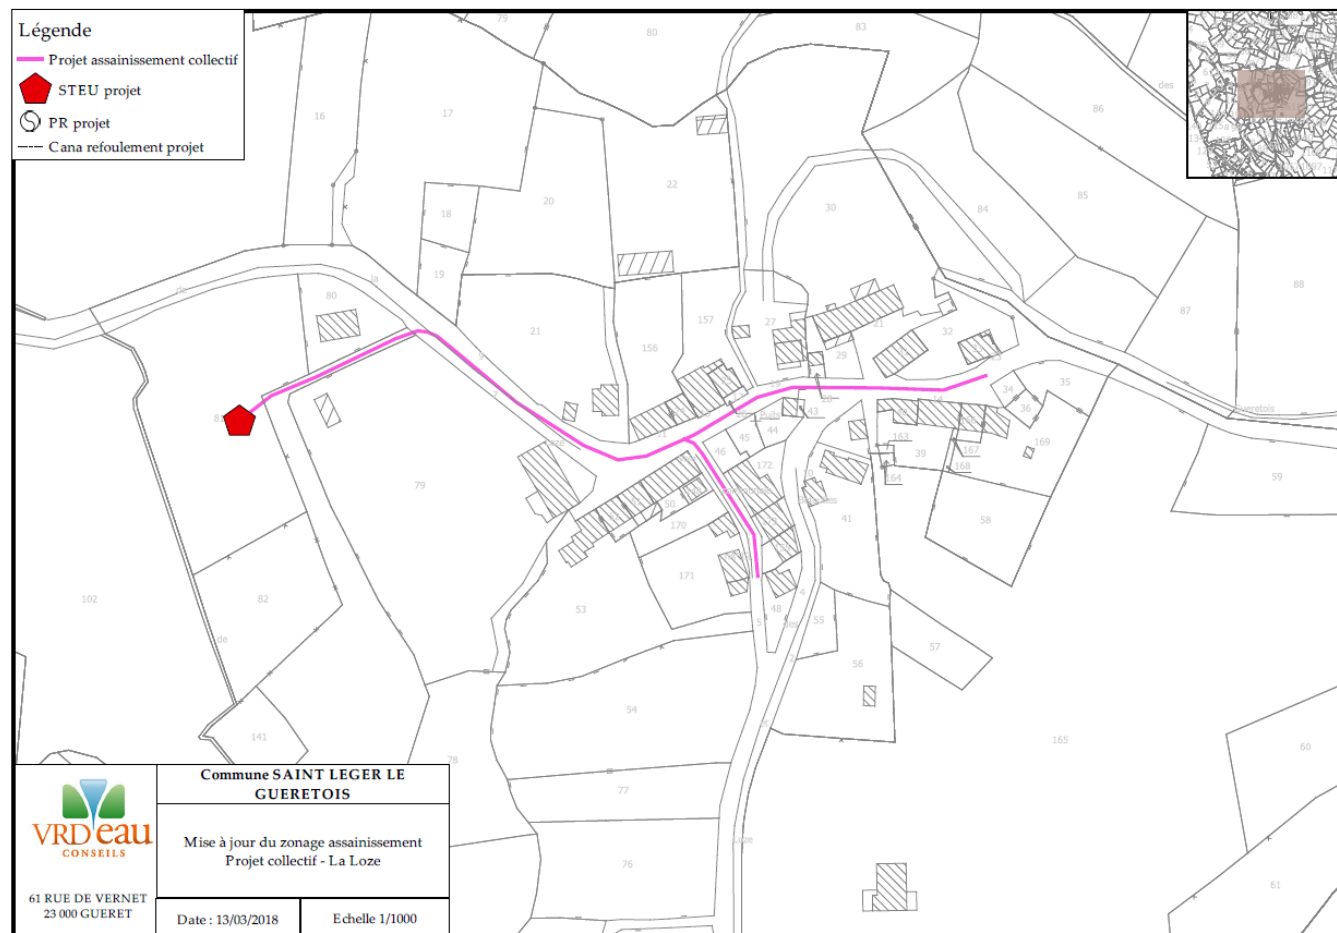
projet d'assainissement collectif sur le village de la Loze
